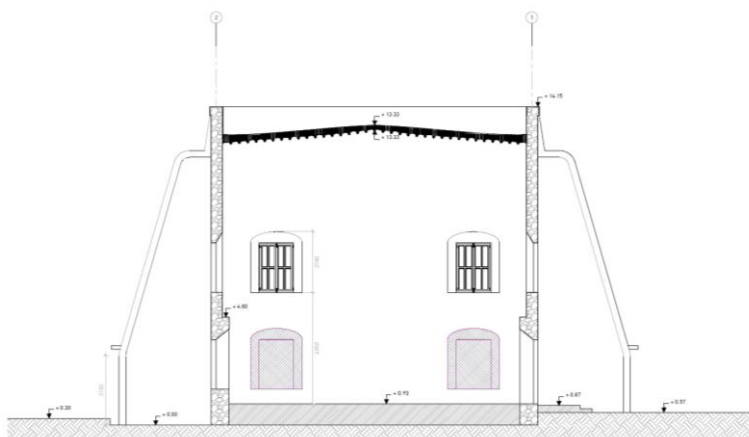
Sección 3.3 del Auditorio. Levantamiento realizado en el año 2019. Fuente: Autora. Ver Planos en los Anexos.
